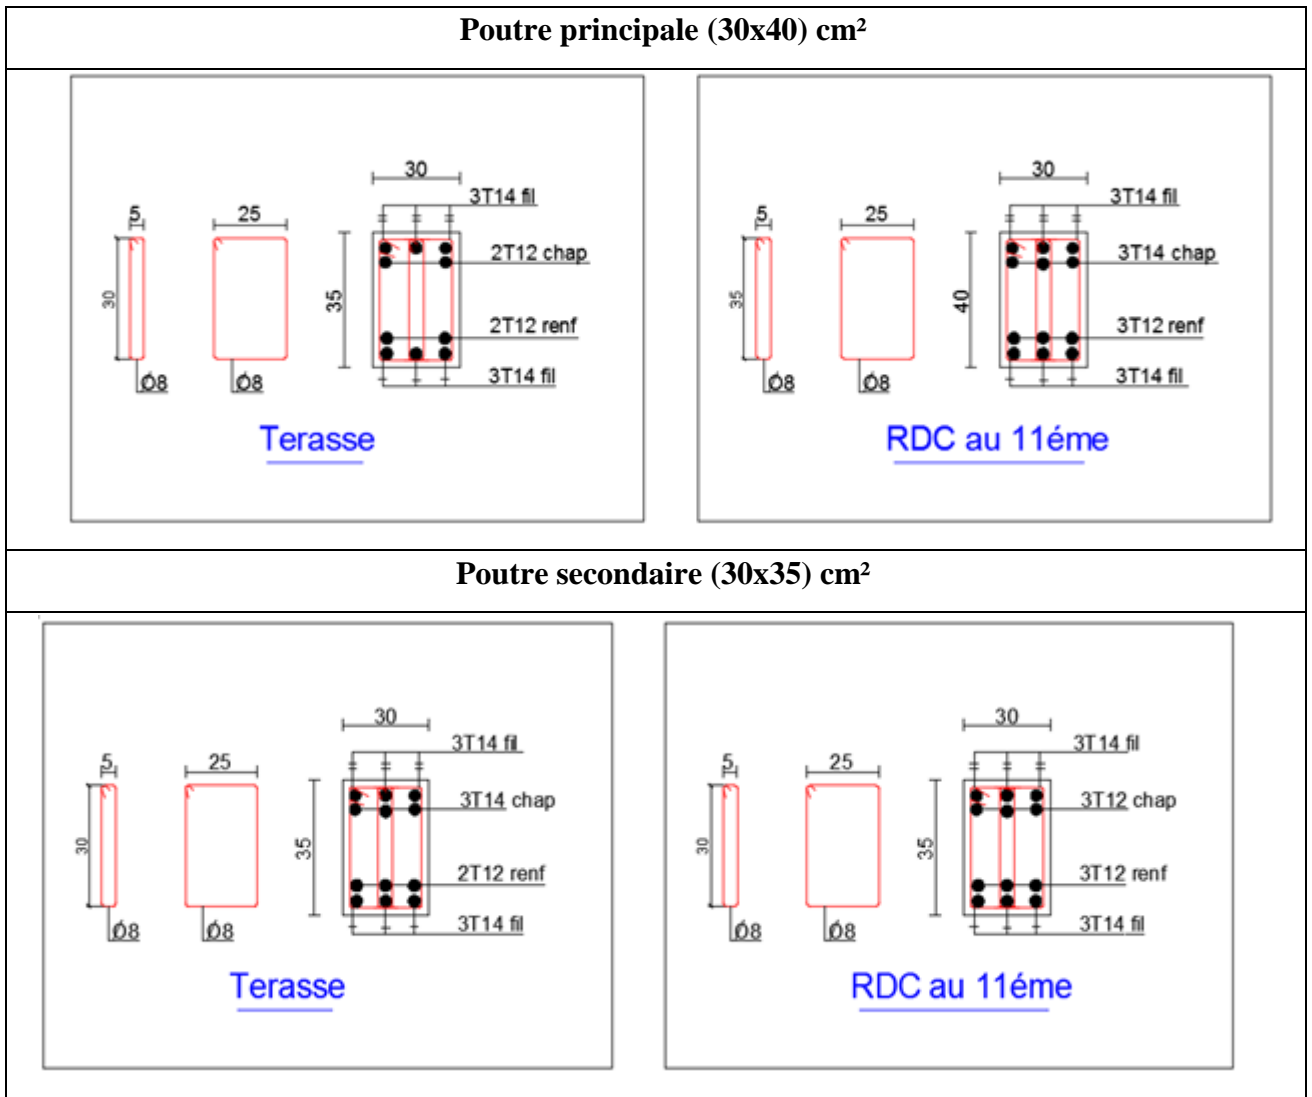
Ferrailage des sections des poutres principales et secondaires.
